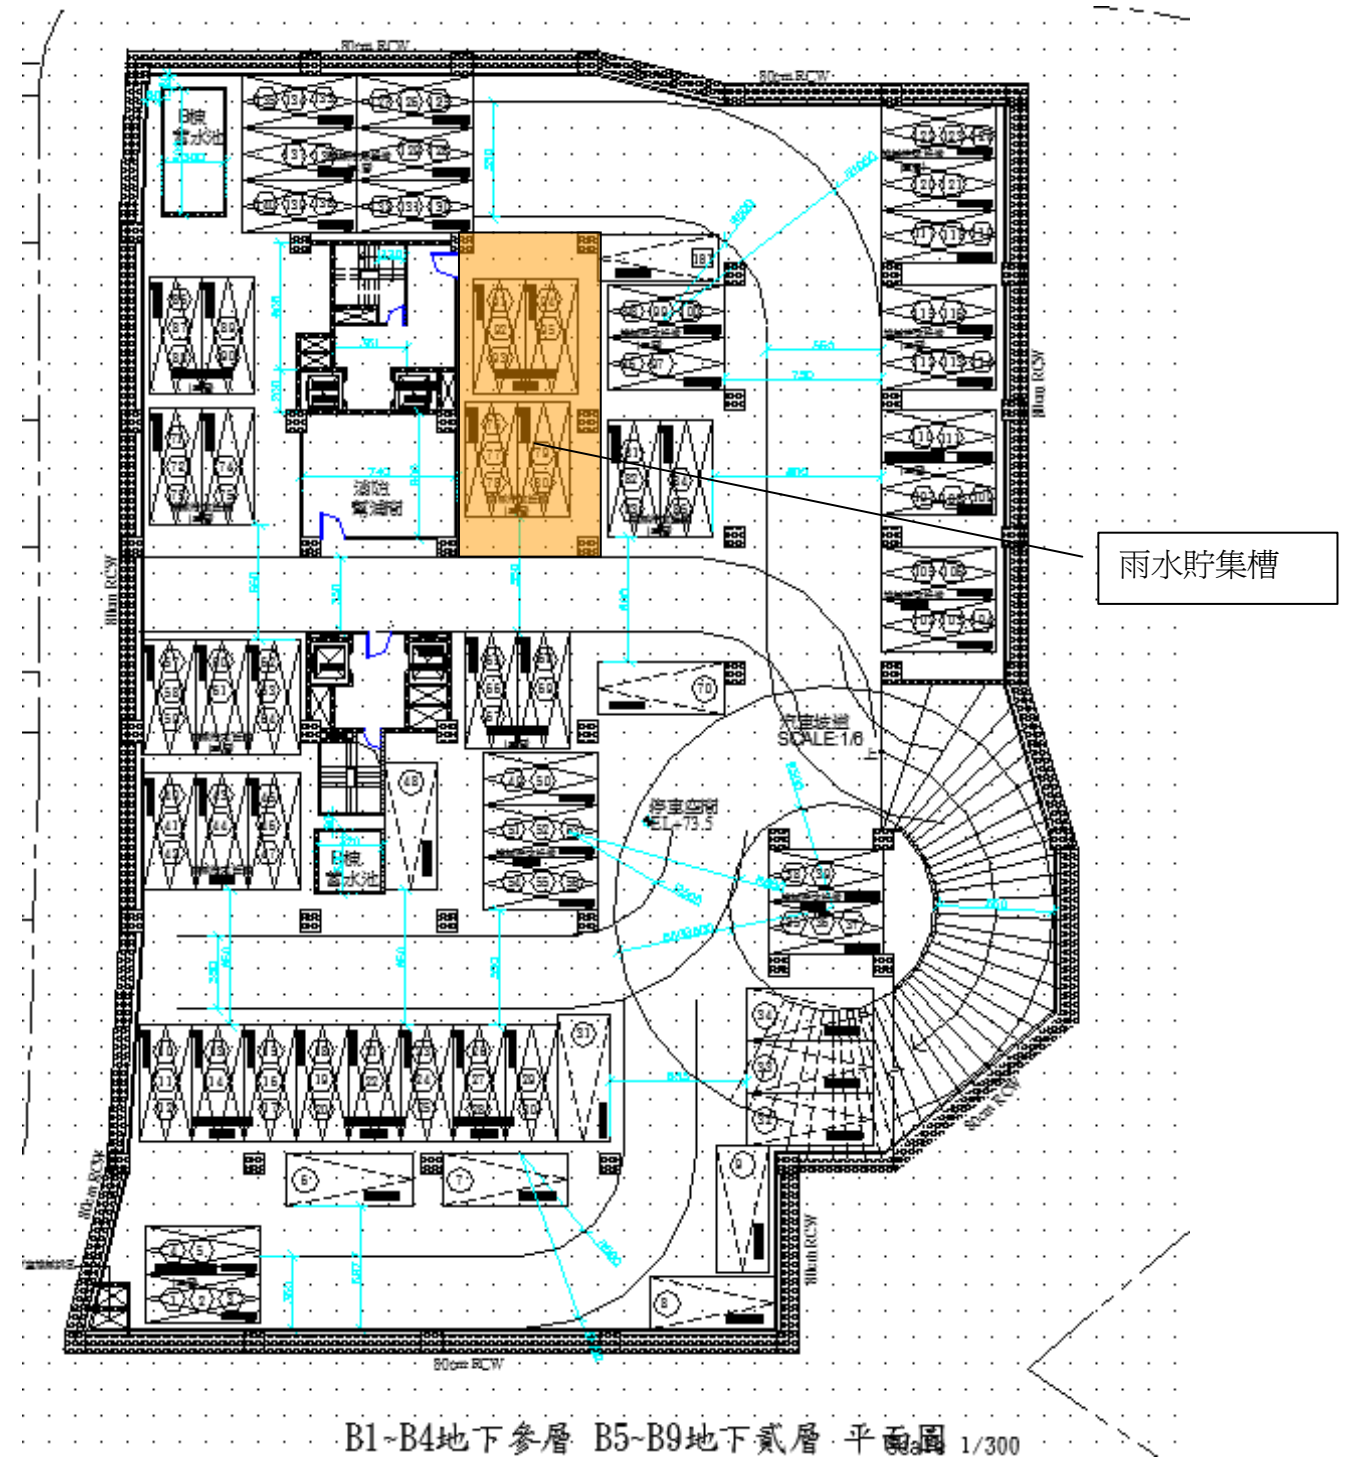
B1~B4 地下參層 B5~B9 地下貳層 平面圖
